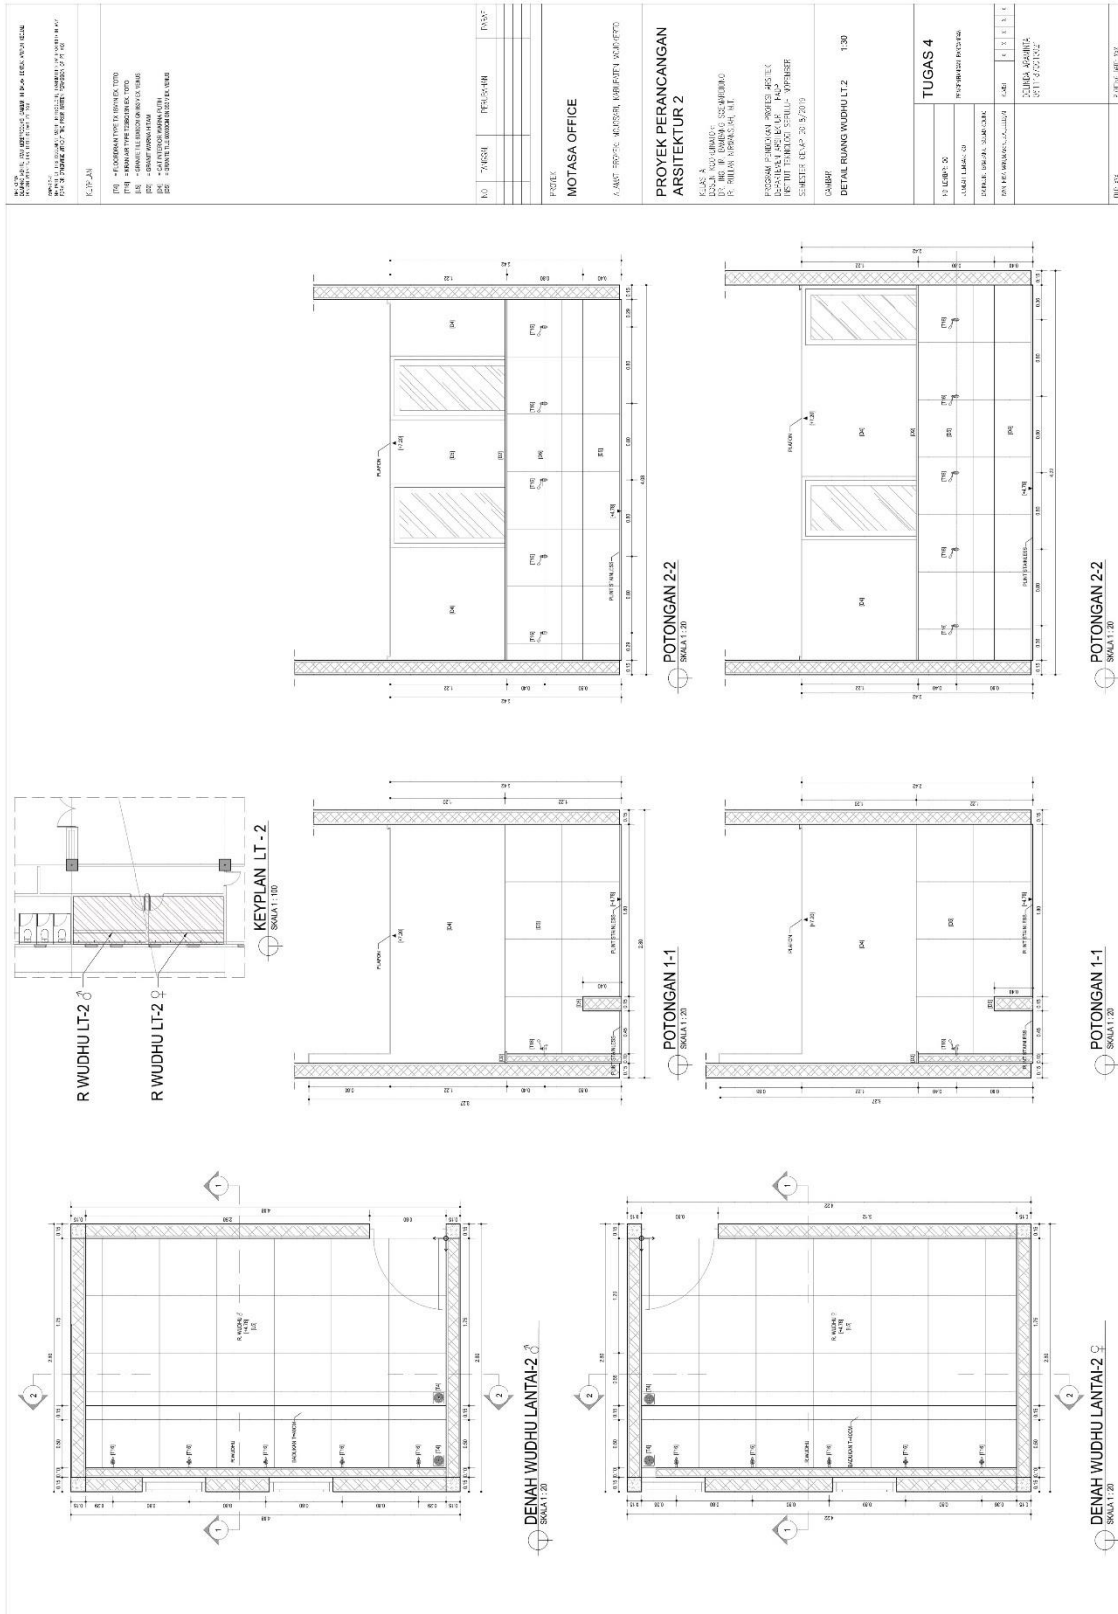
Detail toilet lantai 2 (3)
